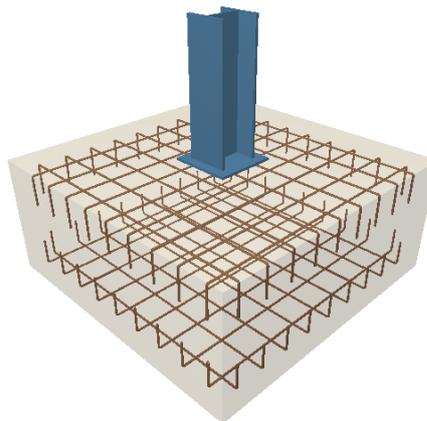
Zapata Z4. Fuente: CYPE 2017
